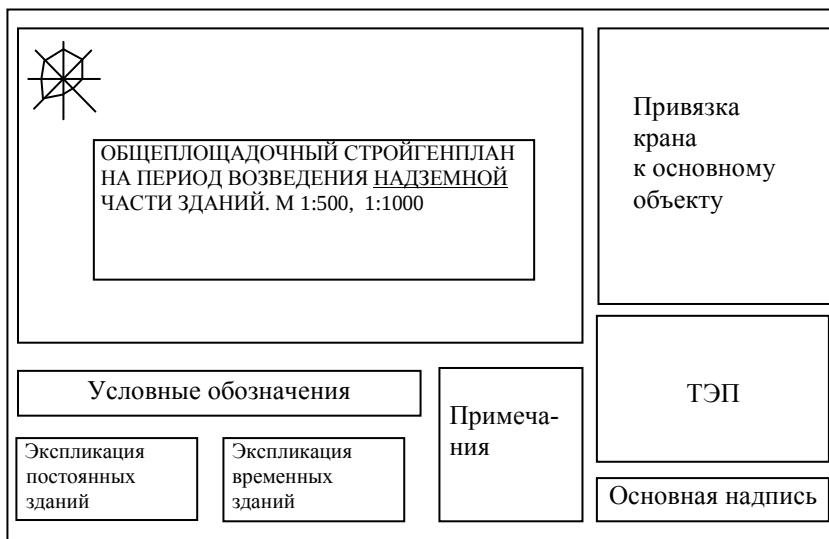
Схема расположения на листе элементов общеплощадочного строительного плана
